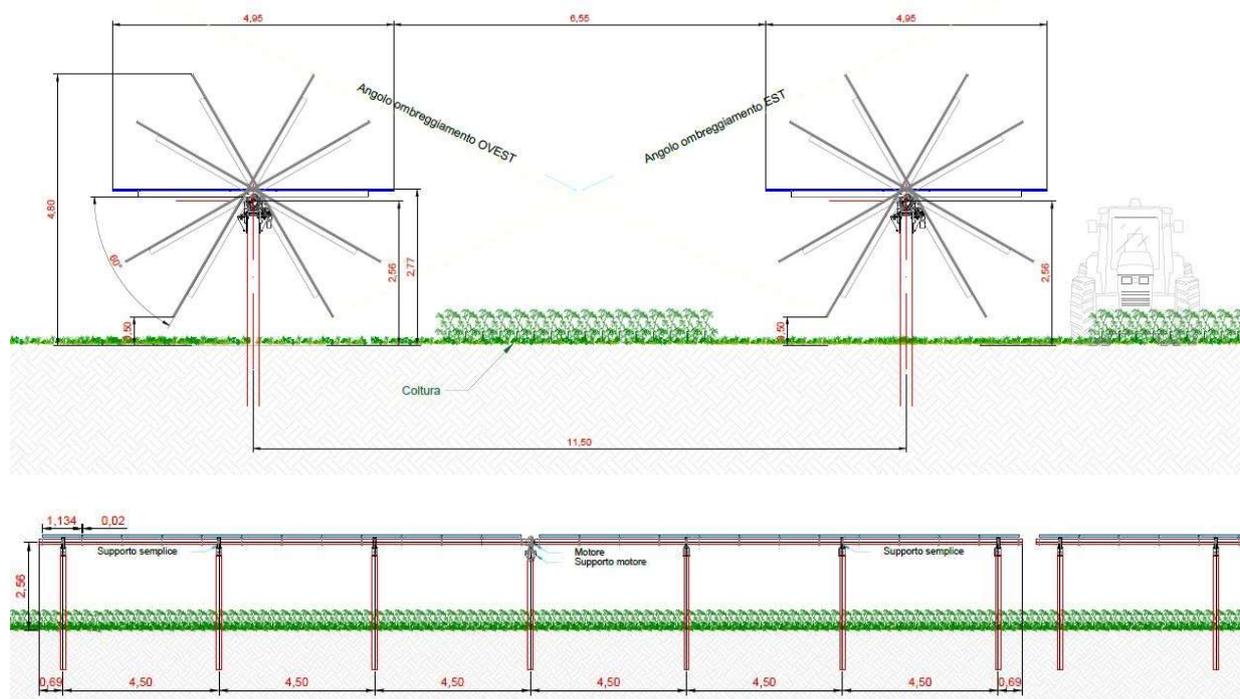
Sezione trasversale tipologica struttura Tracker
